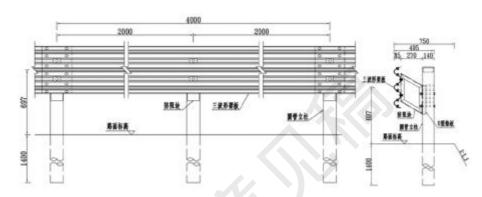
高度自适应波形梁护栏(尺寸单位: mm)
